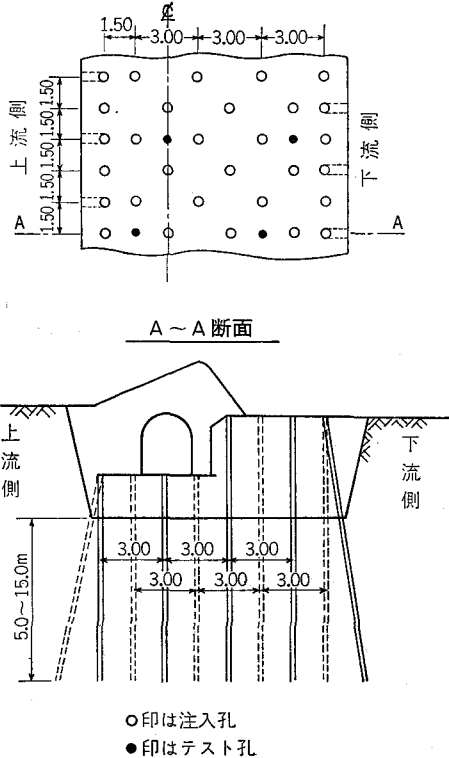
河床部孔配置平面図(施工区間1B L~16B L)
